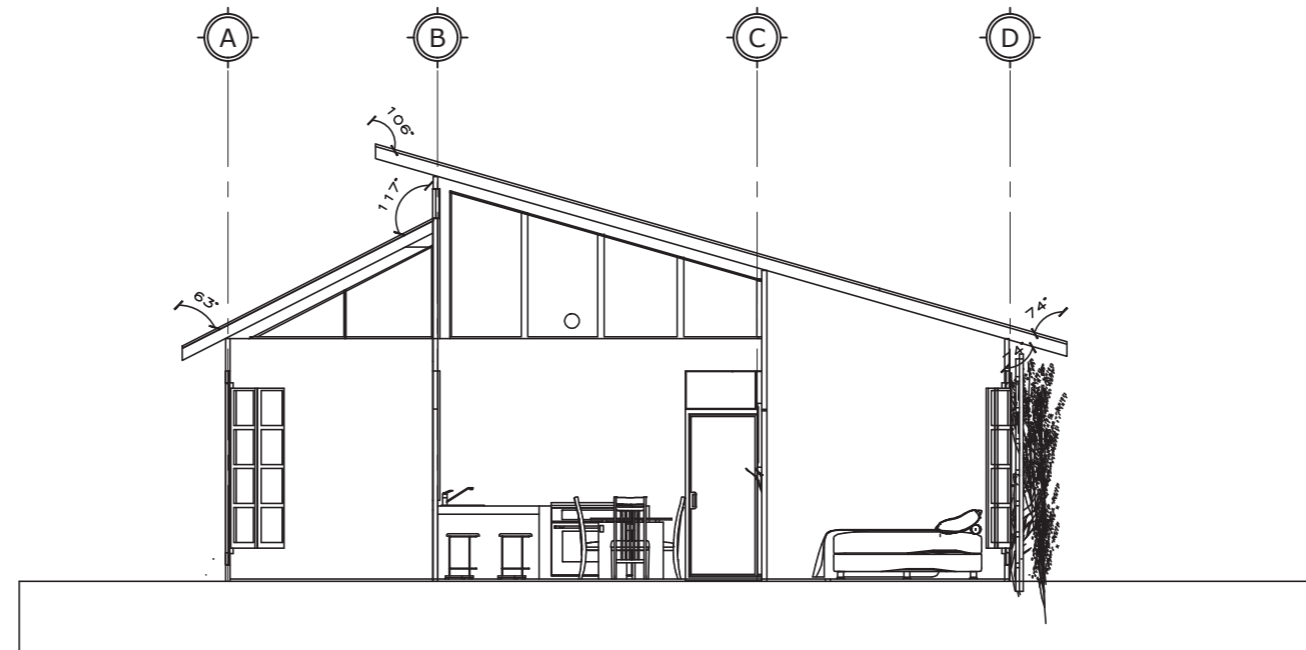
Fachada Frontal -Corte longitudinal RestauranteHospedaje
